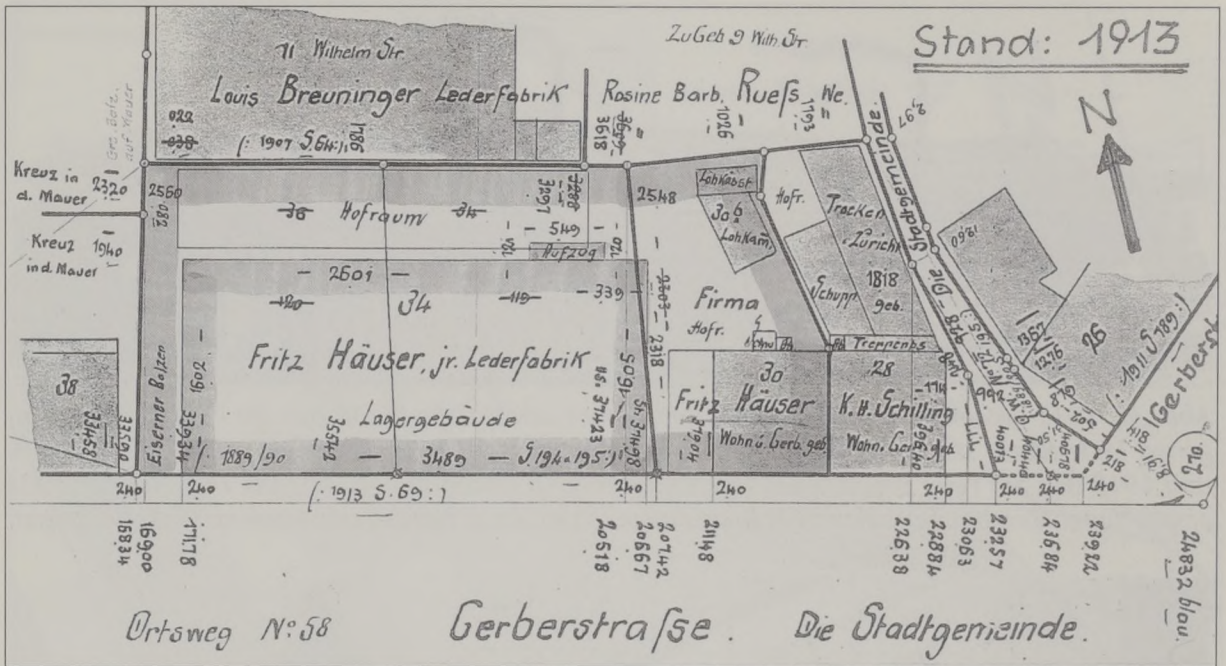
Der Lageplan von 1913 enthält den Grundriss für ein Lagergebäude, das 1914 fertig gestellt wurde.
